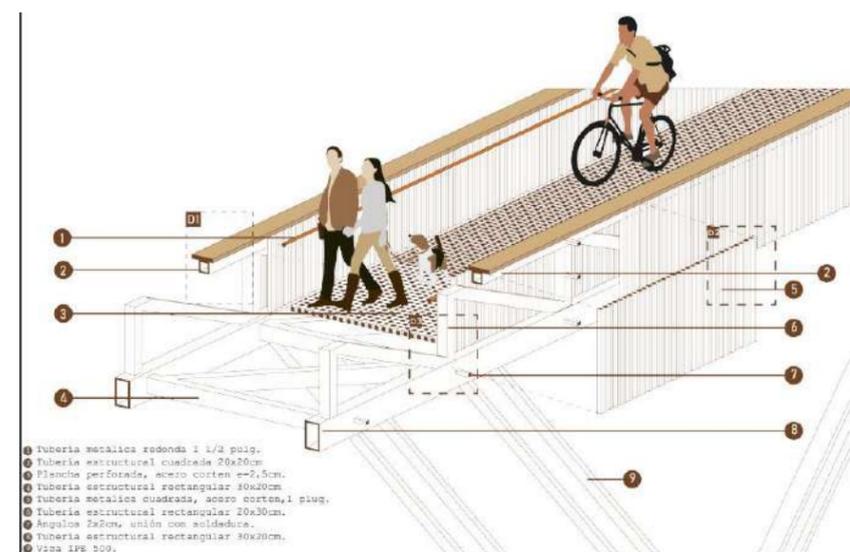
SISTEMA CONSTRUCTIVO DEL PUENTE
